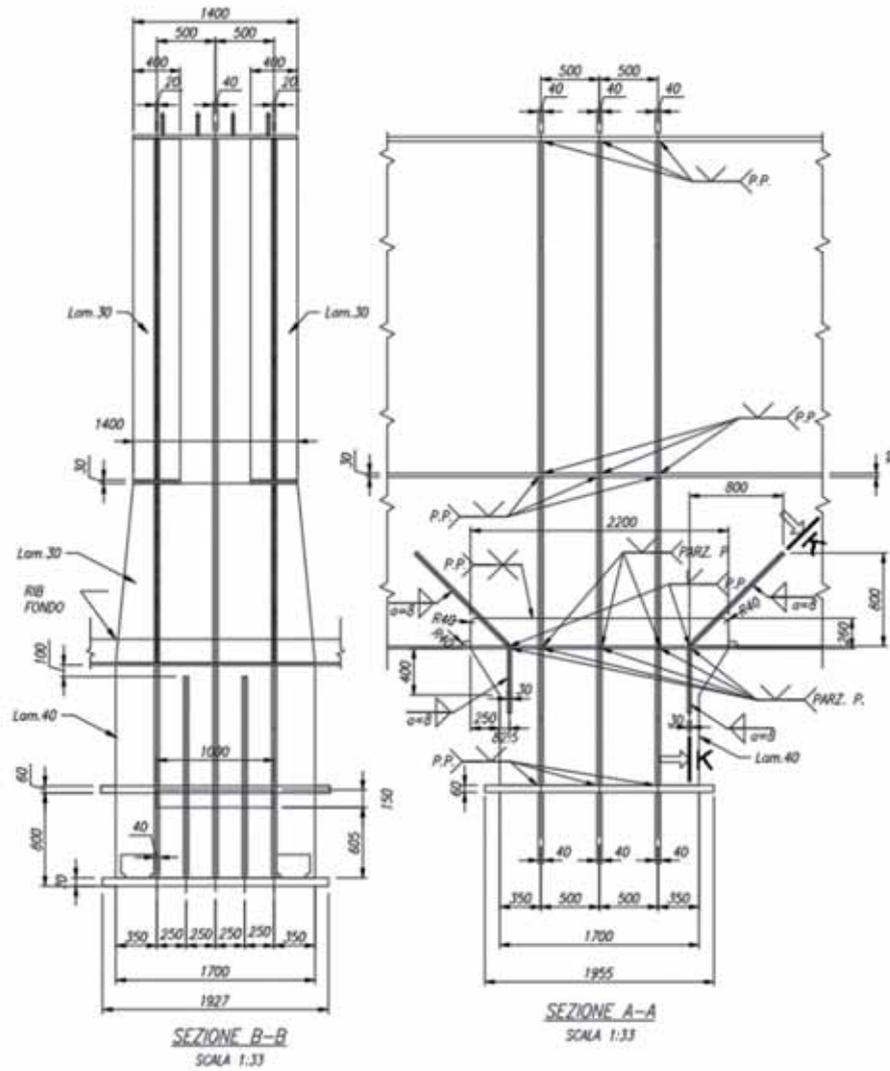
Dettaglio carpenteria gamba e piatti di rinforzo
